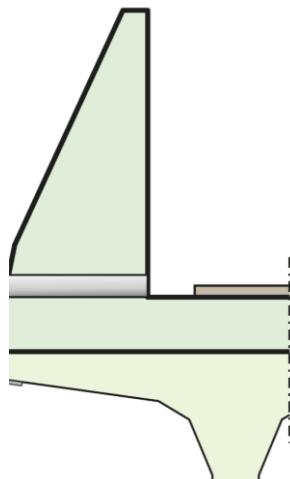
Detalle de caz longitudinal en tablero de puente.
